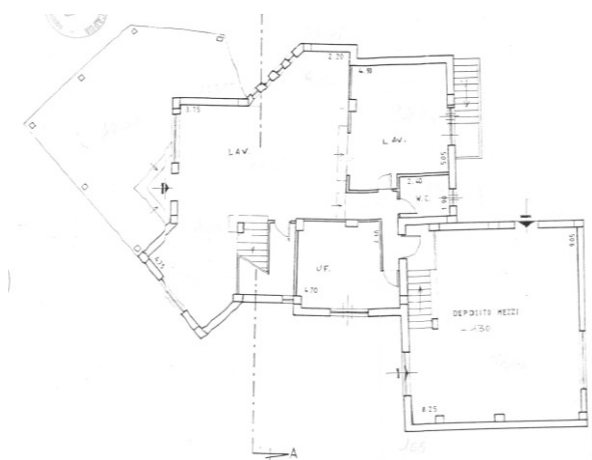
planimetria urbanistica del piano terra della villa secondo la C.E. in sanatoria n.82/1993
